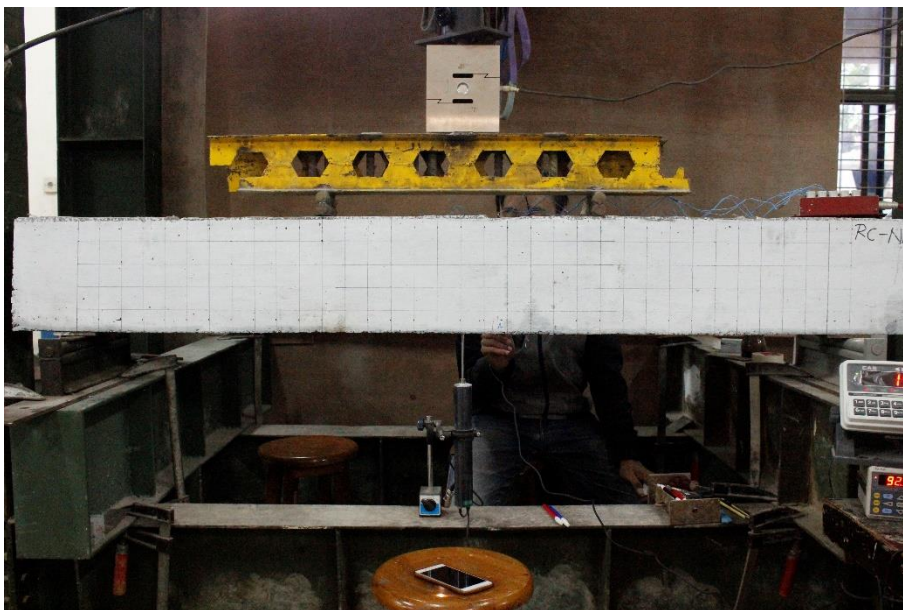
Benda uji silinder dan balok beton bertulang
